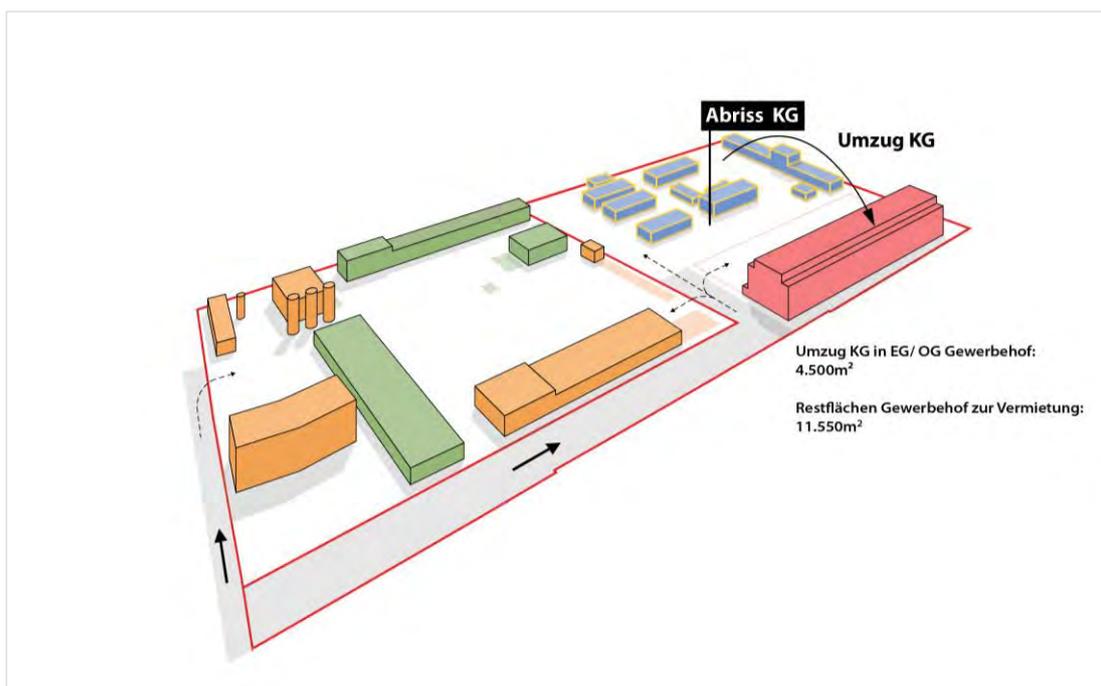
Umzug Kleingewerbe, Abriss Bestandsgebäude Kleingewerbe
